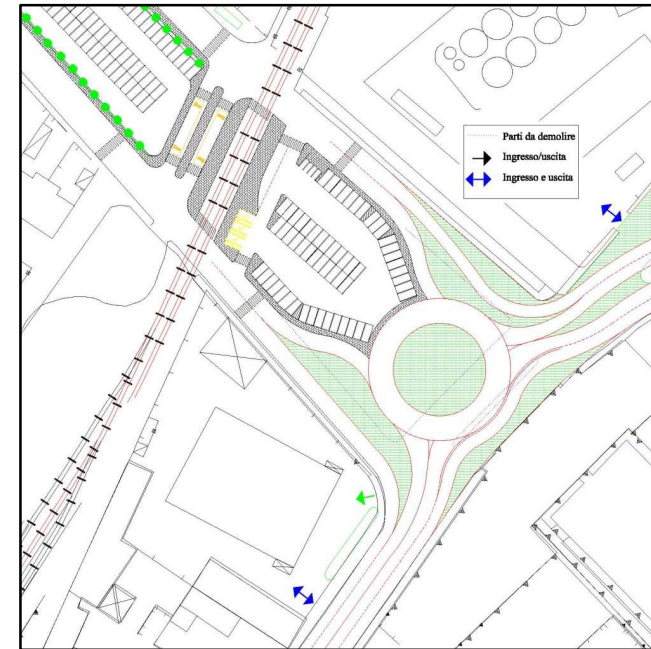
Sistemazione intersezione via Caracalla - via Porto Botte - via Cesare Cabras
